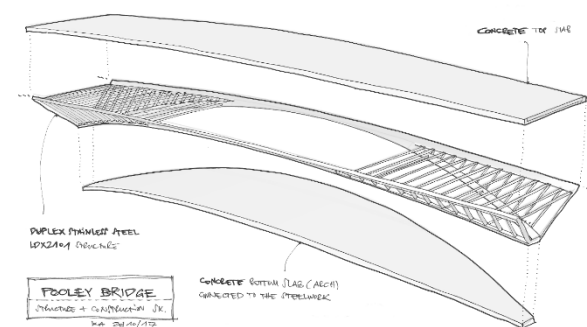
Croquis preliminar reflejando la estructura mixta del vano principal.
